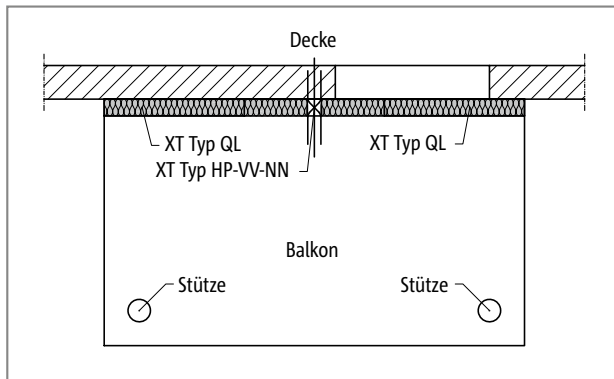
Schöck Isokorb® XT Typ HP: Balkon mit Stützenlagerung
